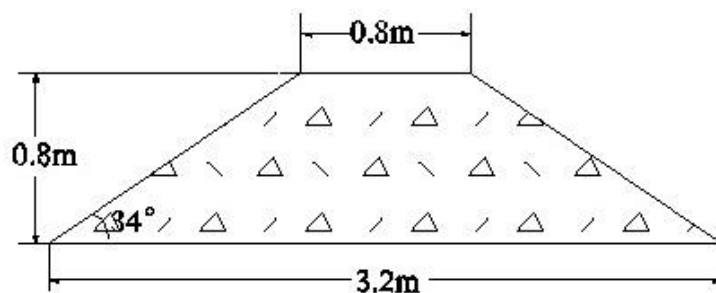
露天采场边坡挡水围堰断面示意图 (单位: m)
